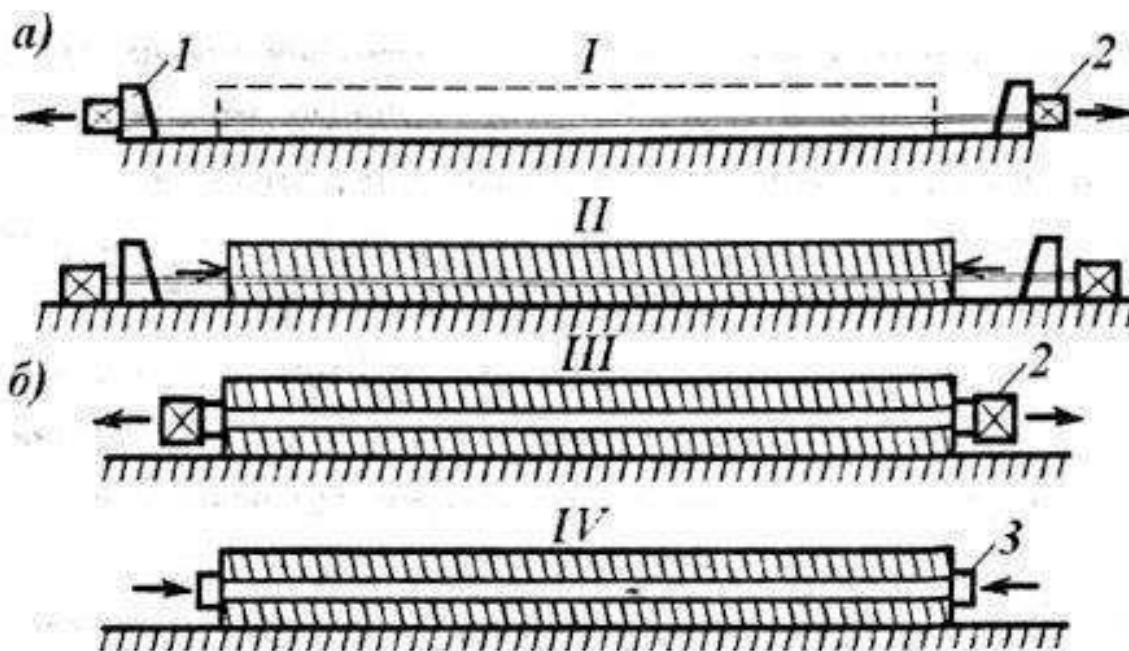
Способы предварительного напряжения железобетонных конструкций: а – «на опоры», б – «на бетон»;
